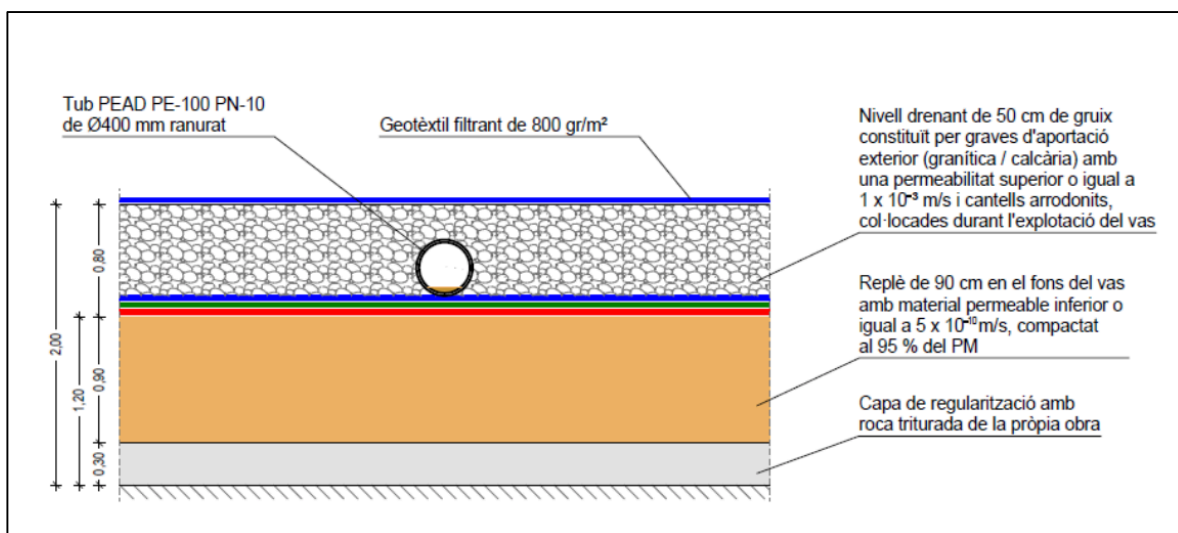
Sección tipo del sistema tradicional de impermeabilización y drenaje del vertedero de Orís.
